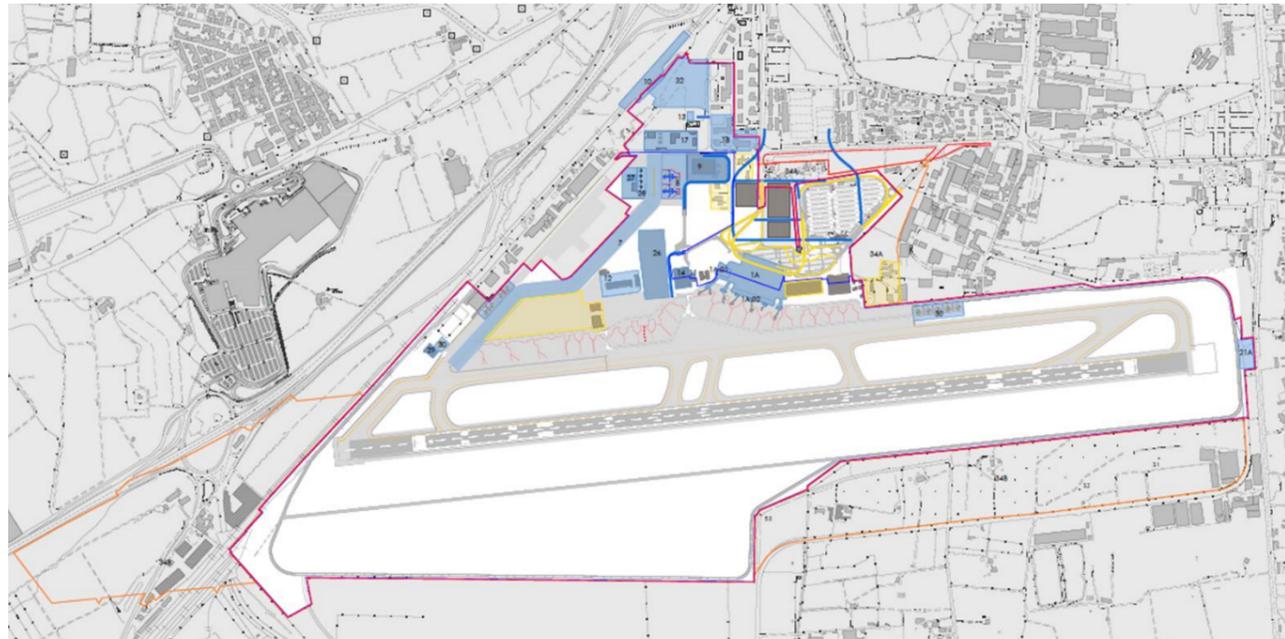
Documentazione progettuale integrativa – Stralcio della Tavola 08 – Planimetria Demolizioni – Costruzioni
